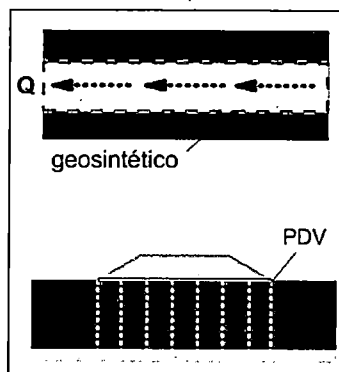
Drenes verticales prefabricados (PVD'S)
